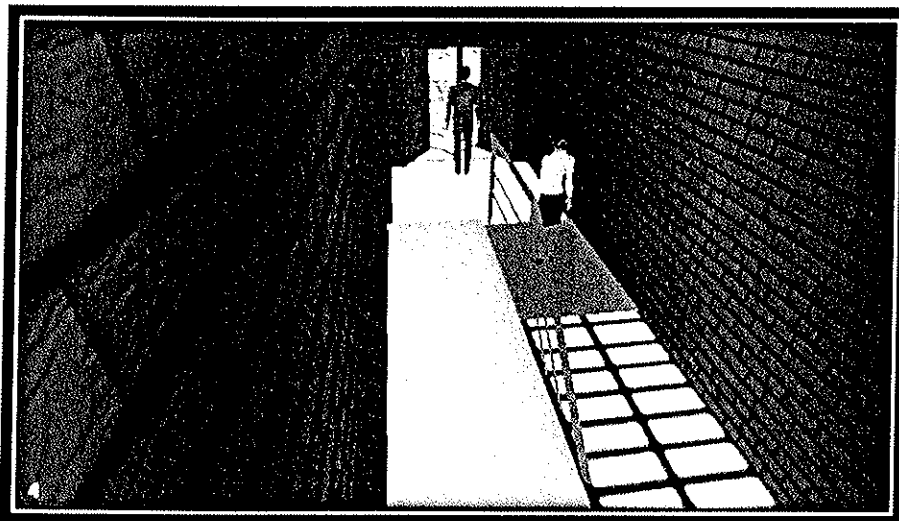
Vista de la Salida de Emergencia Tipo 2
